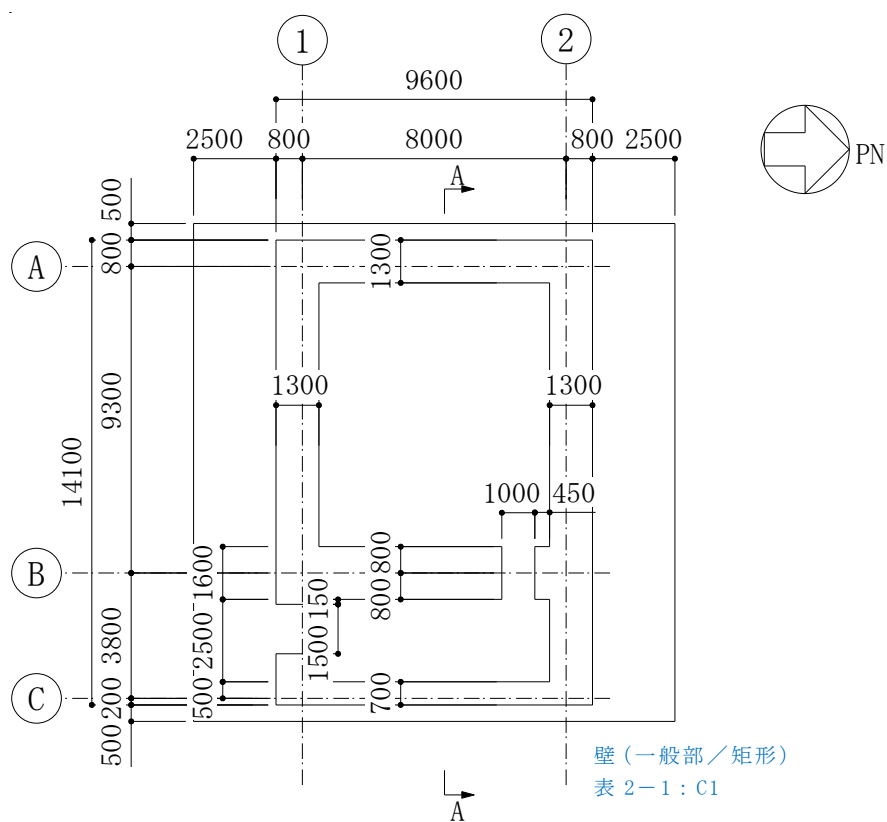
格納容器圧力逃がし装置基礎の概略平面図
